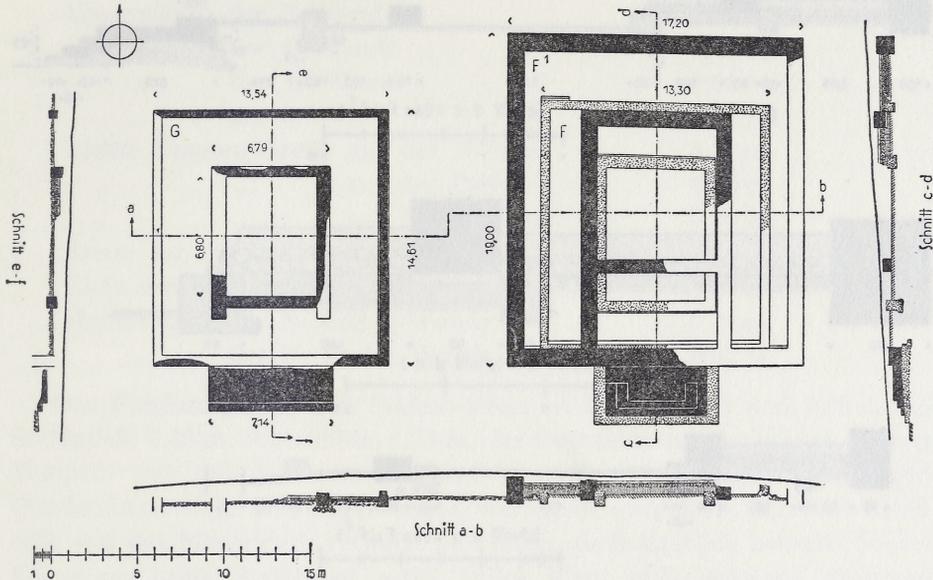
Grundrisse der Umgangstempel G und F.
